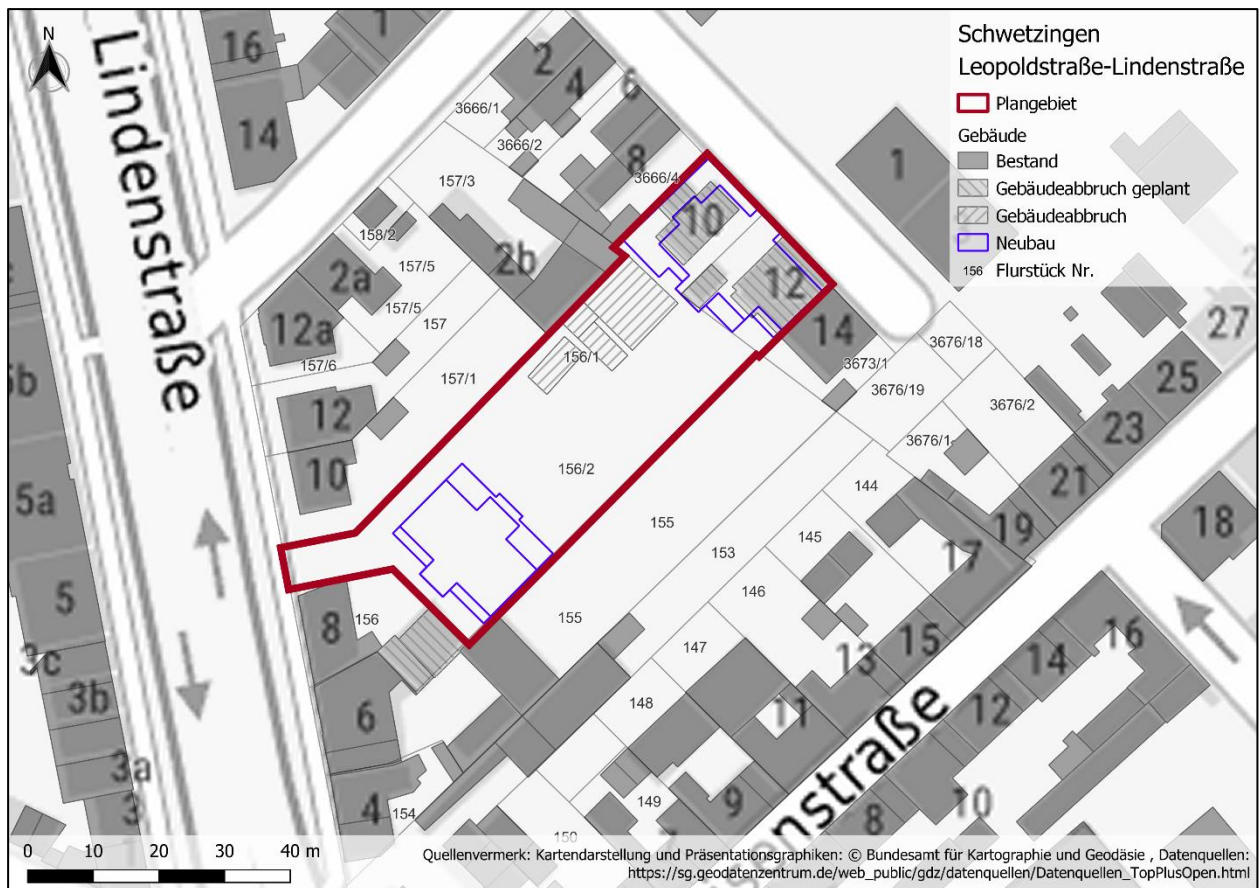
Lageplan für die Umgebung des Plangebietes mit bisherigem Gebäudebestand innerhalb des Plangebietes.
